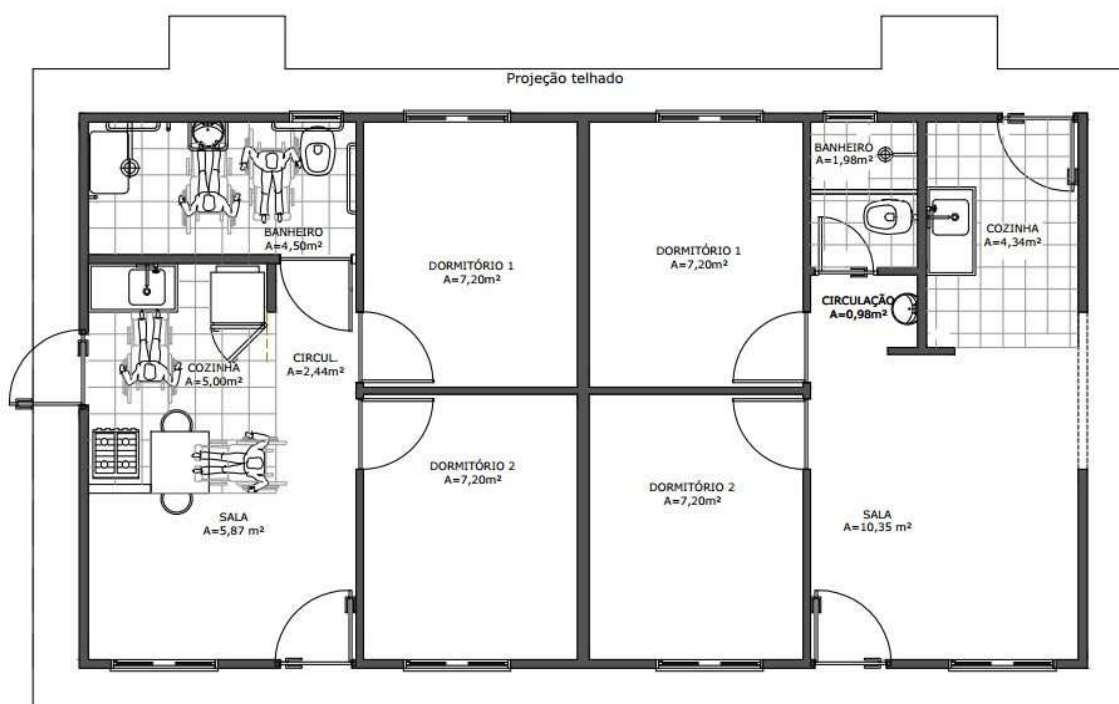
Planta Baixa Loteamento Zilda Arns, unidade adaptada à PNE.
